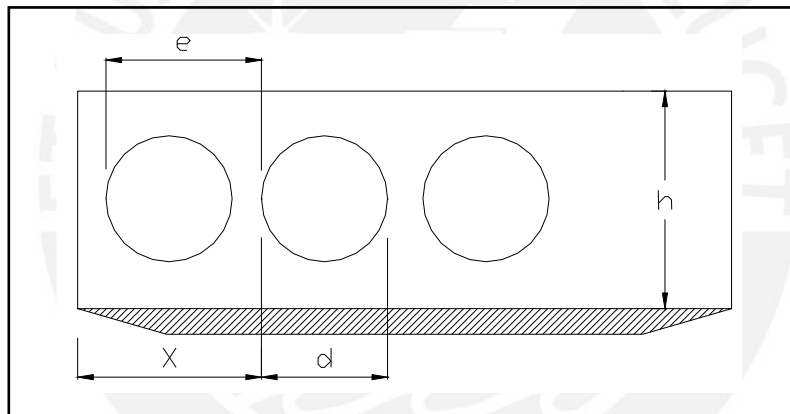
Viga de acero para conductos de refrigeración. (Lottaz, 1999)
